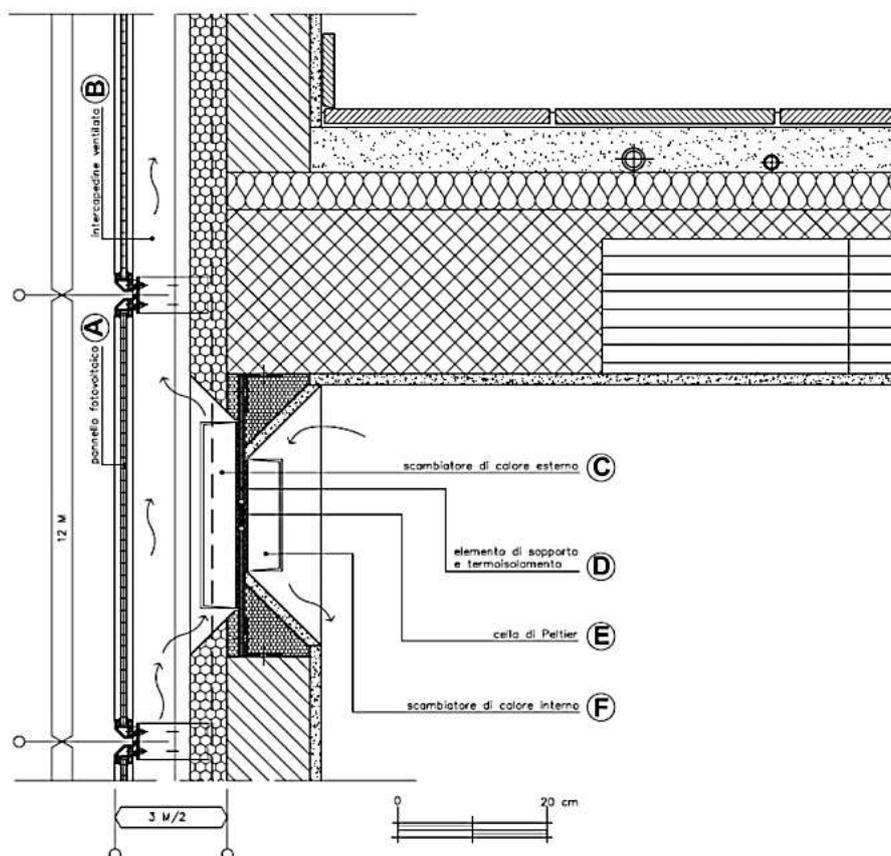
Sezione verticale del sistema di facciata raffrescante autoregolante
